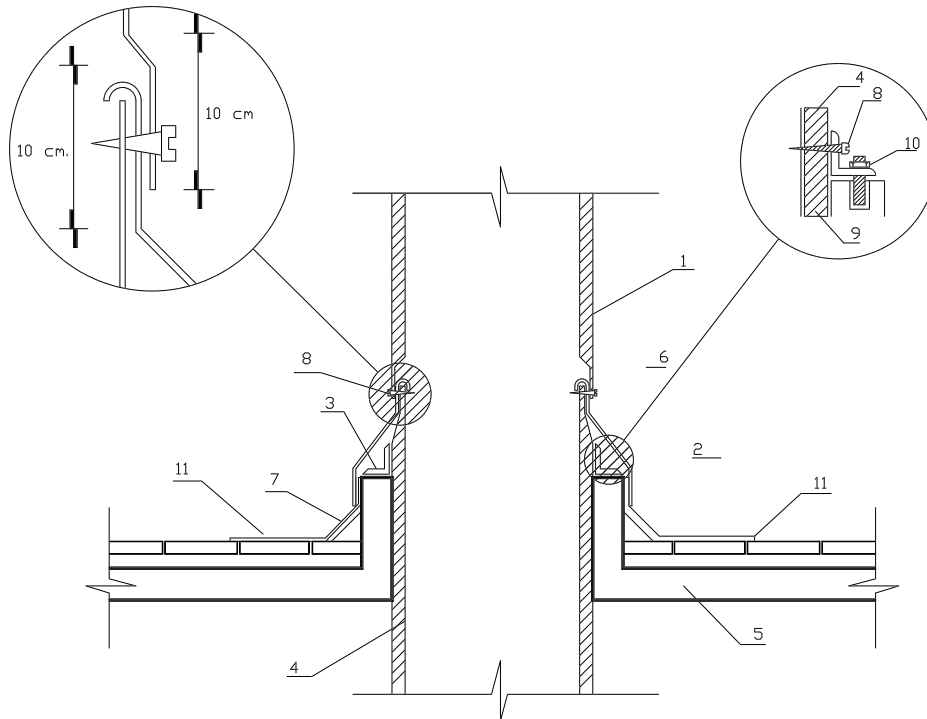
PASO DE DUCTO AISLADO EN LOSA EXTERIOR.
